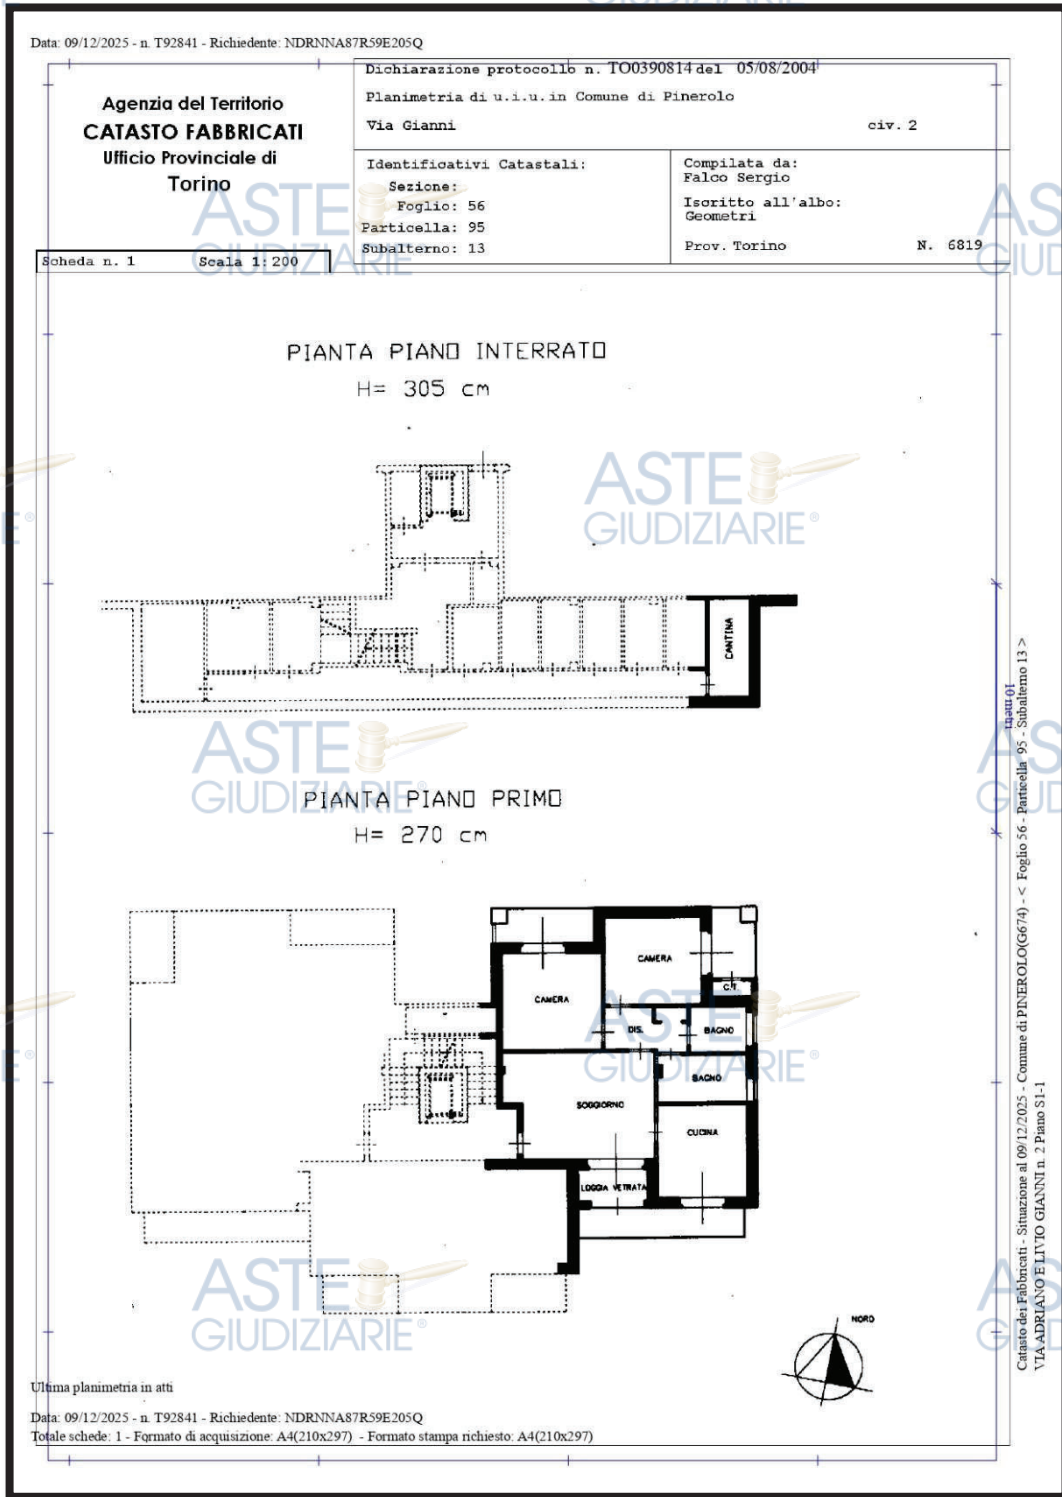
Planimetria catastale prot. n. TO0390814 appartamento e cantina P. 1 – S1
